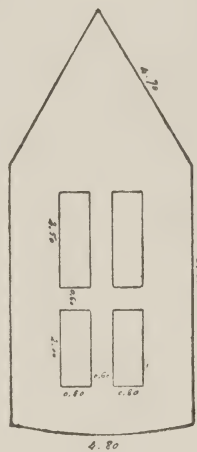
PLANTA DE UNA DE LAS FILAS
